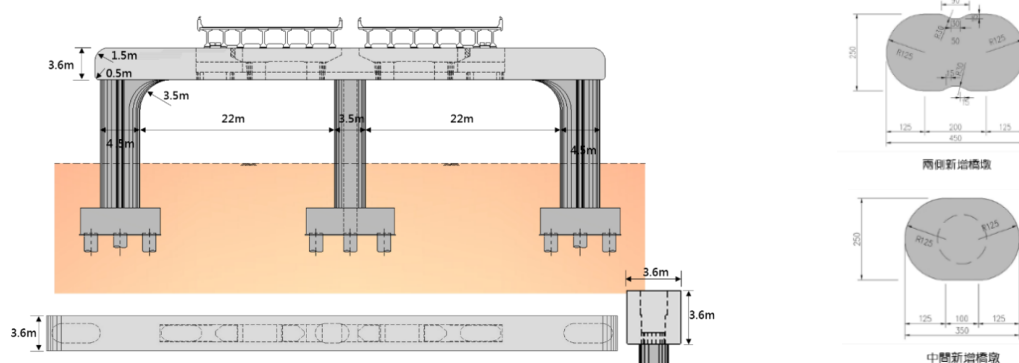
中沙大橋改建完成後結構配置及斷面示意圖
